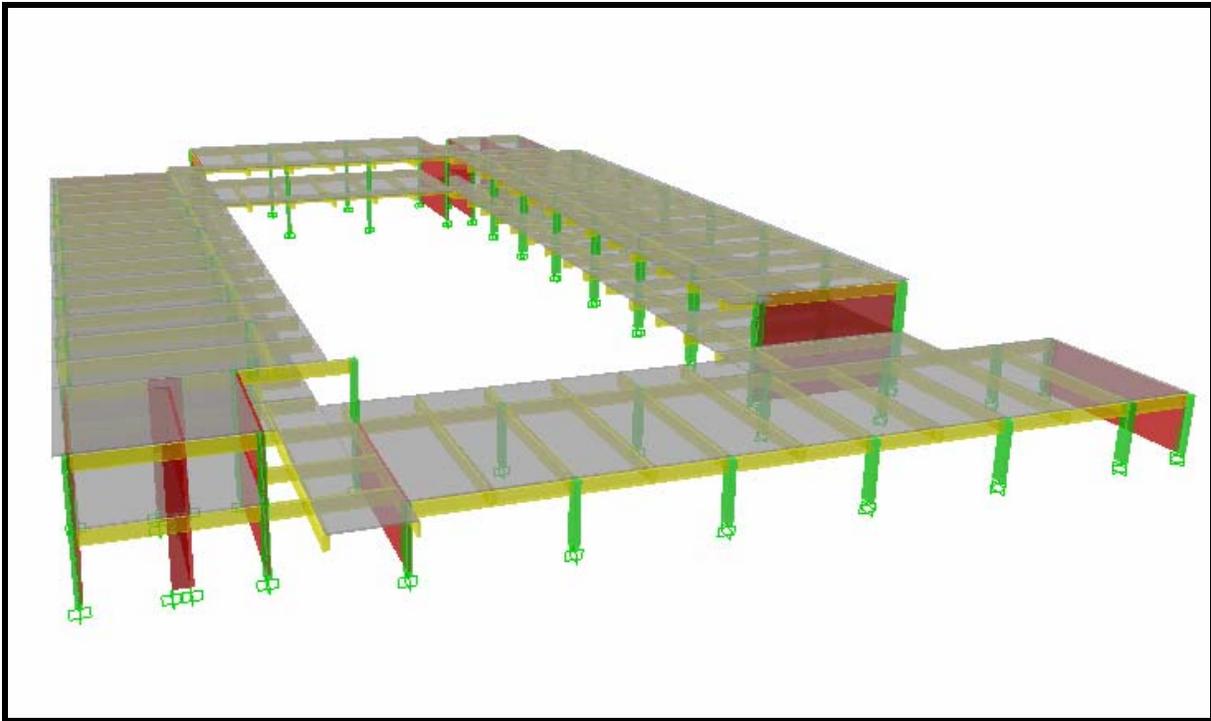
Modelo estructural de la escuela Las Palmas (adaptado de Hernández 2007)
